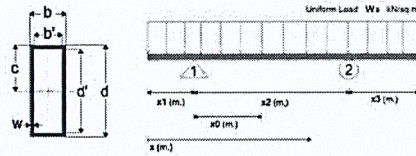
รายการคำนวณคานรับพื้นทำงานด้านนอก (Working Platform Girder Outside)
